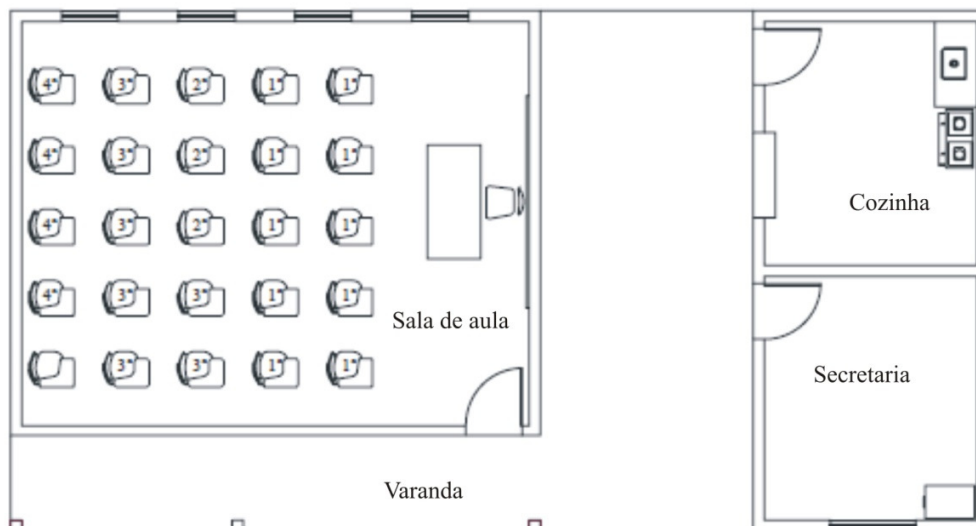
Planta Baixa e imagem de uma escola multisseriada
